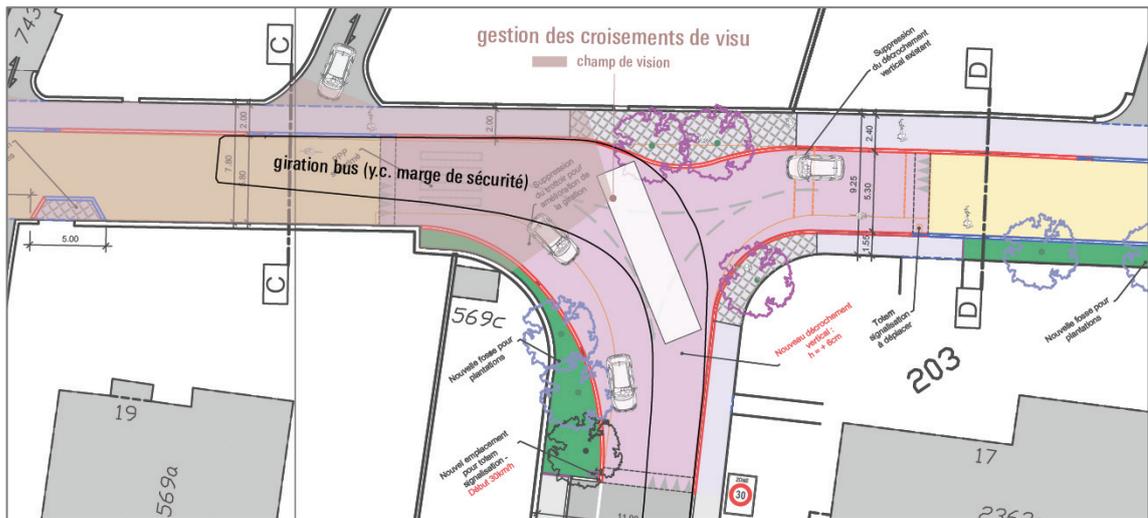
schéma illustratif du carrefour Clos d'Aubonne – Edouard-Müller, fond de plan extrait du plan MCR
